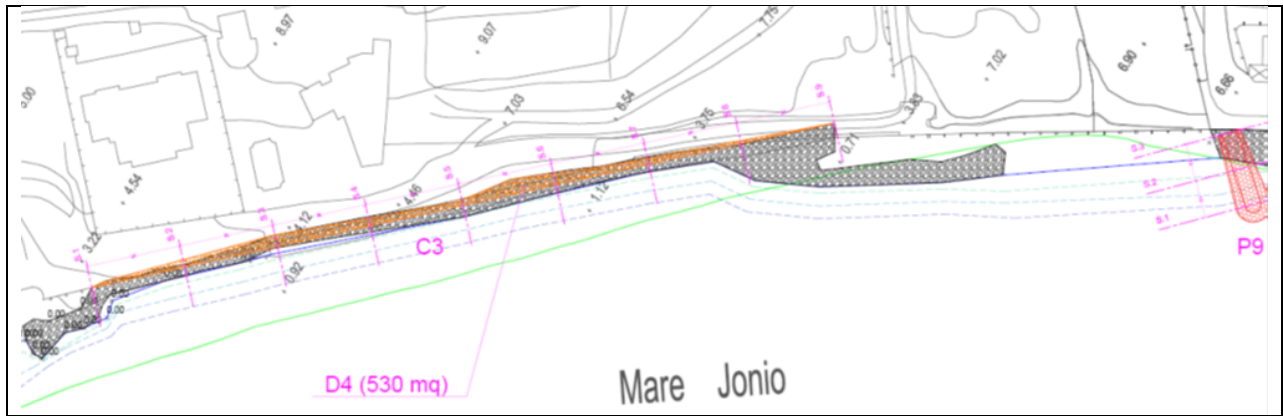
Schema planimetrico intervento Lazzaro area B Torrente Saetta – Torrente S. Vincenzo
